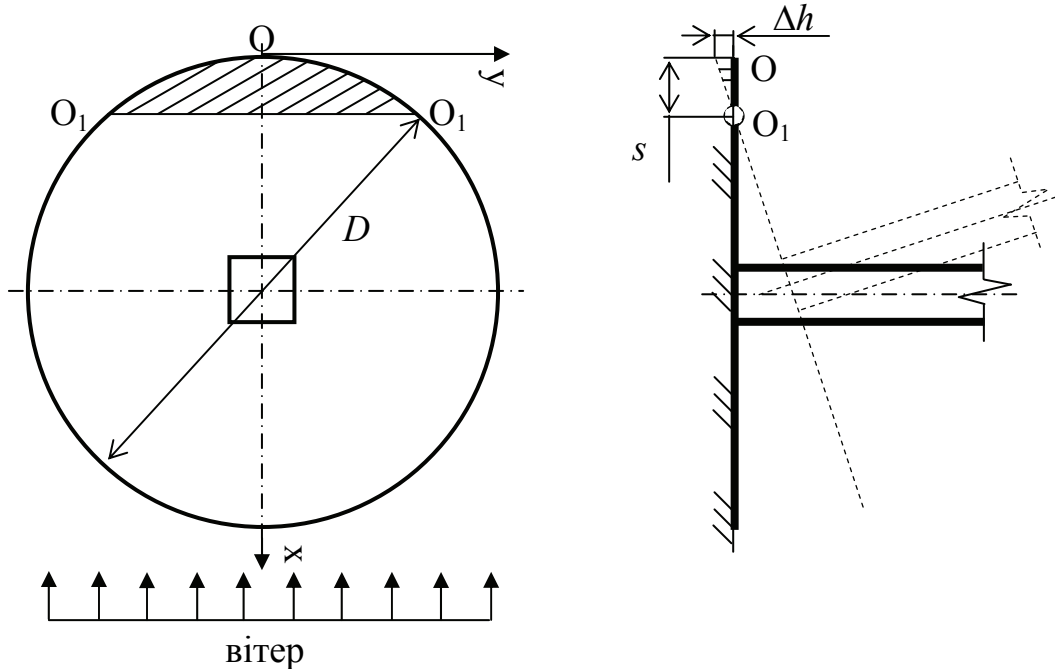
Розрахункова схема опорної платформи безфундаментної баштової споруди, що влаштована на пружному ґрунті, у момент перекидання
